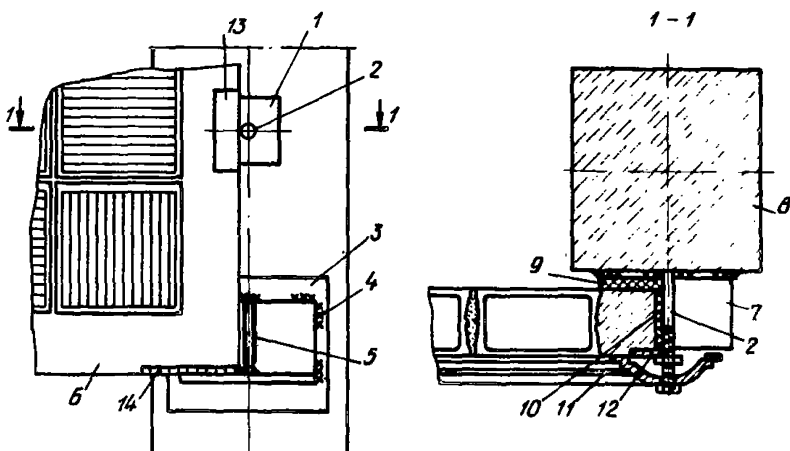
Вариант крепления вертикальной стекложелезобетонной панели к стойке каркаса
